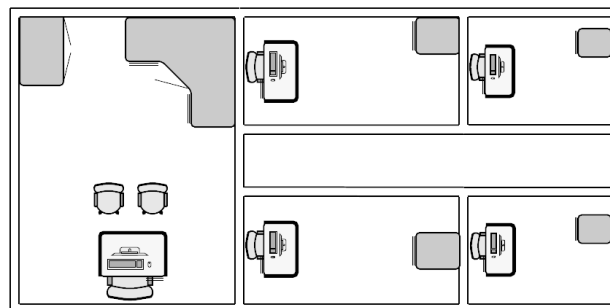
Oficinas de planta. Fuente: Elaboración propia.
